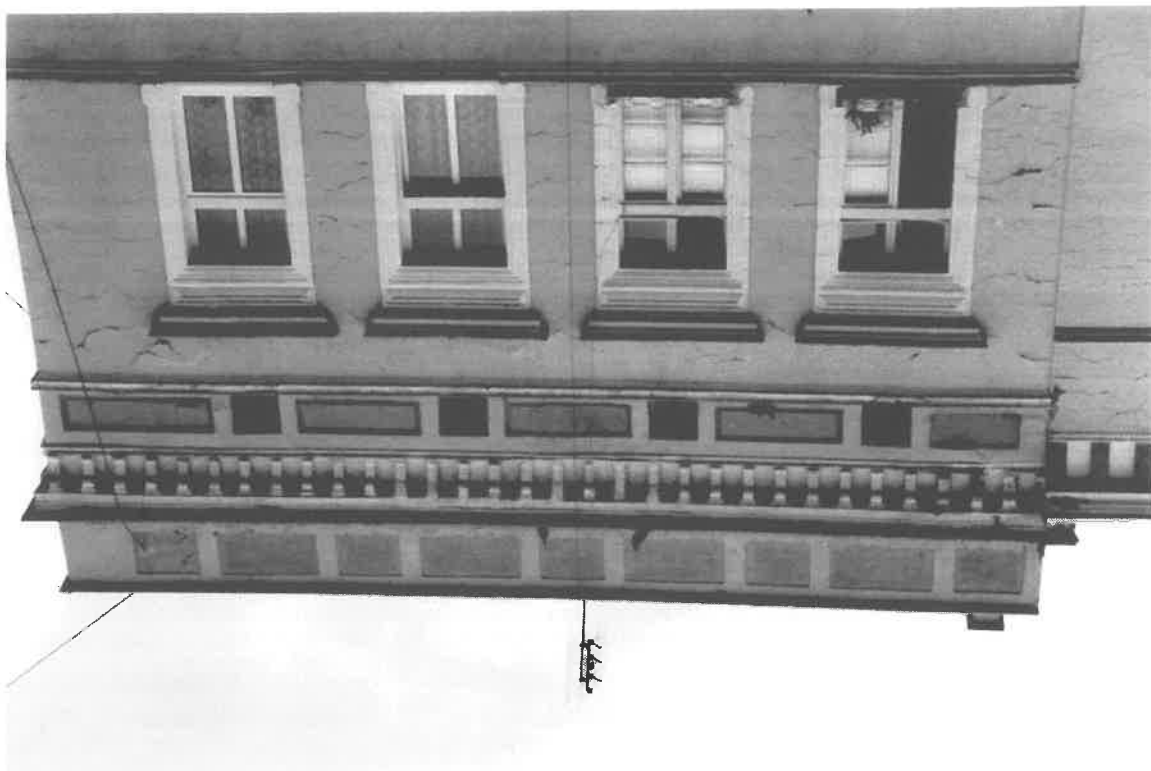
/10. Kamienica Rynek 1, elewacja wschodnia (widok od południowego-
